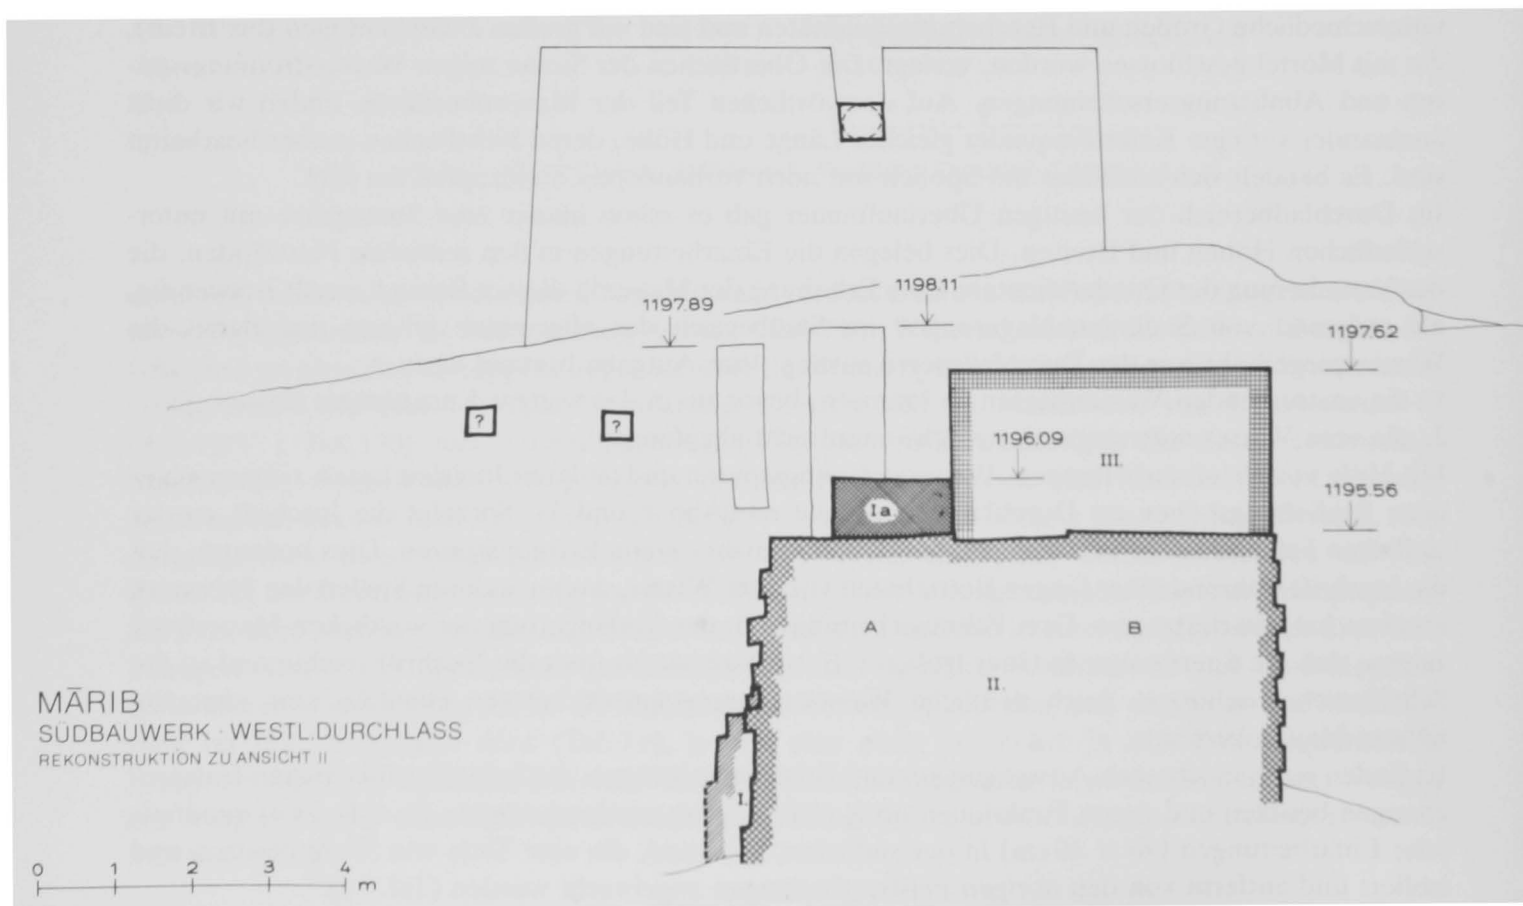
Mārib, Damm. Südbauwerk. Westlicher Durchlaß. Rekonstruktion zu Ansicht II.
